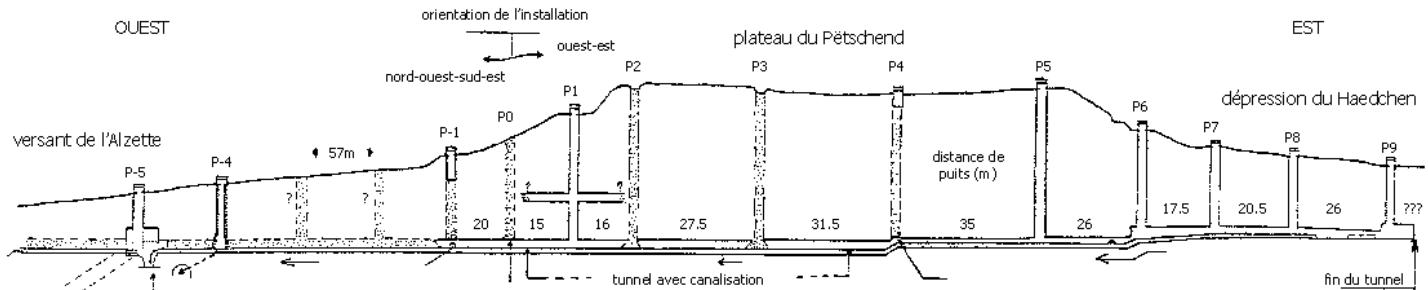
Coupe longitudinale de la partie de l'installation explorée à ce jour.
